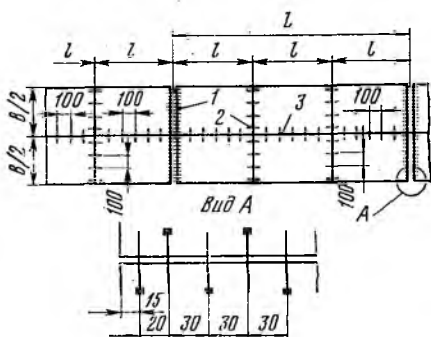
Схема расположения швов цементобетонного покрытия:
